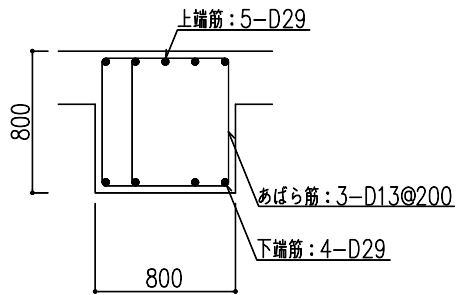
大ばりの配筋図 (屋上階, X2 通り YK~YL 通り間, 端部) (単位: mm)
